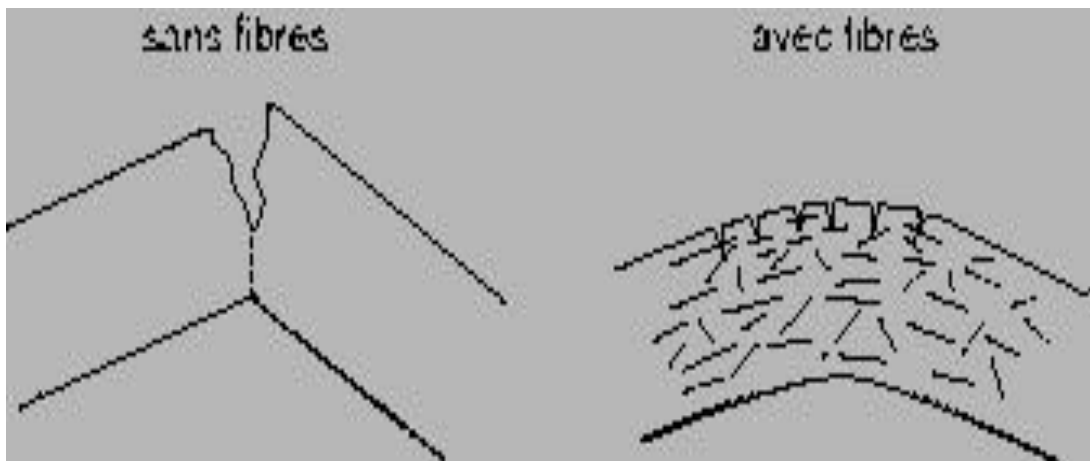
Fissuration dans le béton sans et avec fibres [4]
